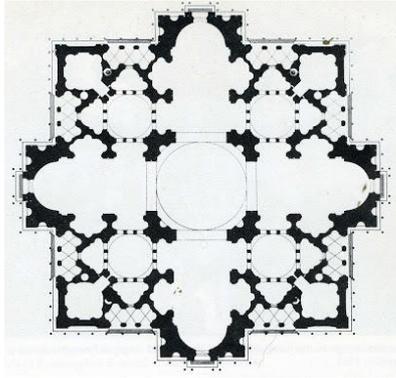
Donato Bramante. Proyecto de planta para la nueva basílica de San Pedro, el Vaticano. Hacia 1505. Imagen procedente de LETAROUILLY, Paul-Marie, 1882.
